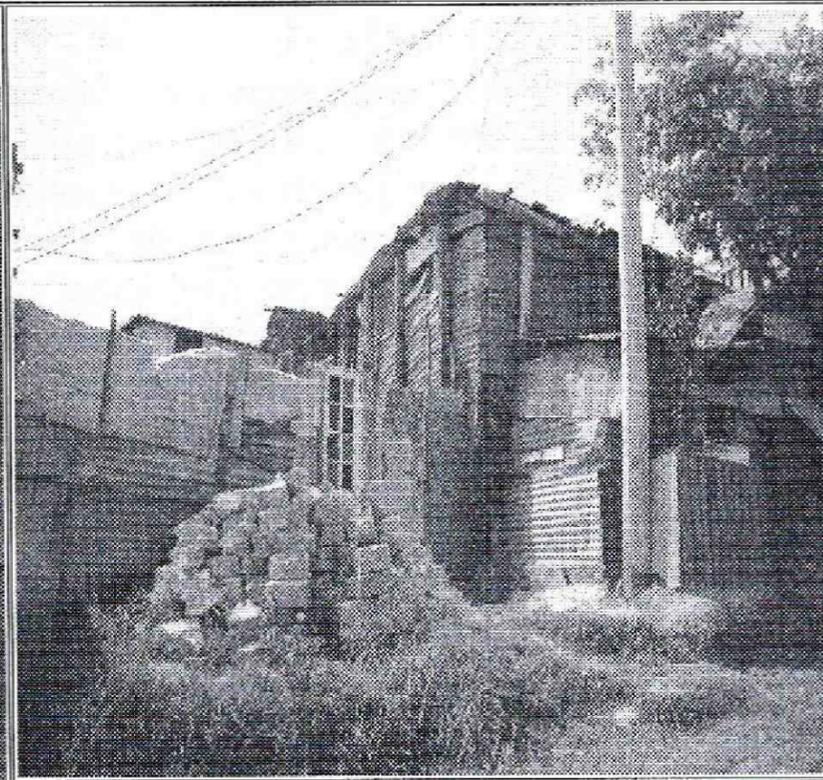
Vista lateral del predio de la Calle 81D Sur No. 18C-18 Barrio San Rafael Sur Localidad de Ciudad Bolívar
